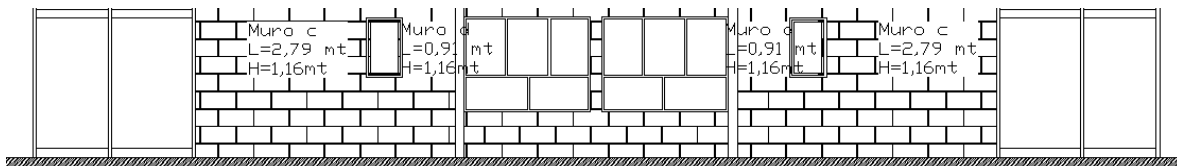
37. Fachada Eje Y, edificio 5 pisos
